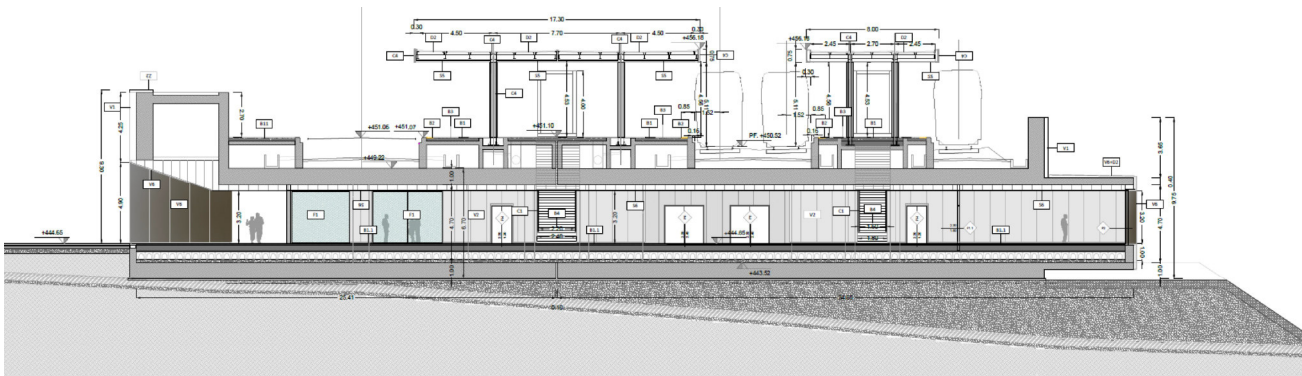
Stazione di Dittaino: Sezione trasversale in corrispondenza area commerciale/attesa
